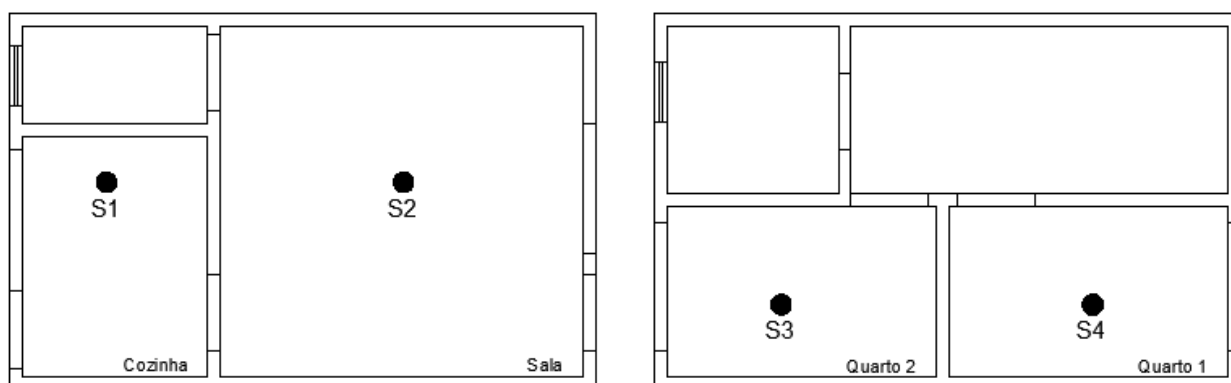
Distribuição dos sensores na edificação de dois pavimentos.
